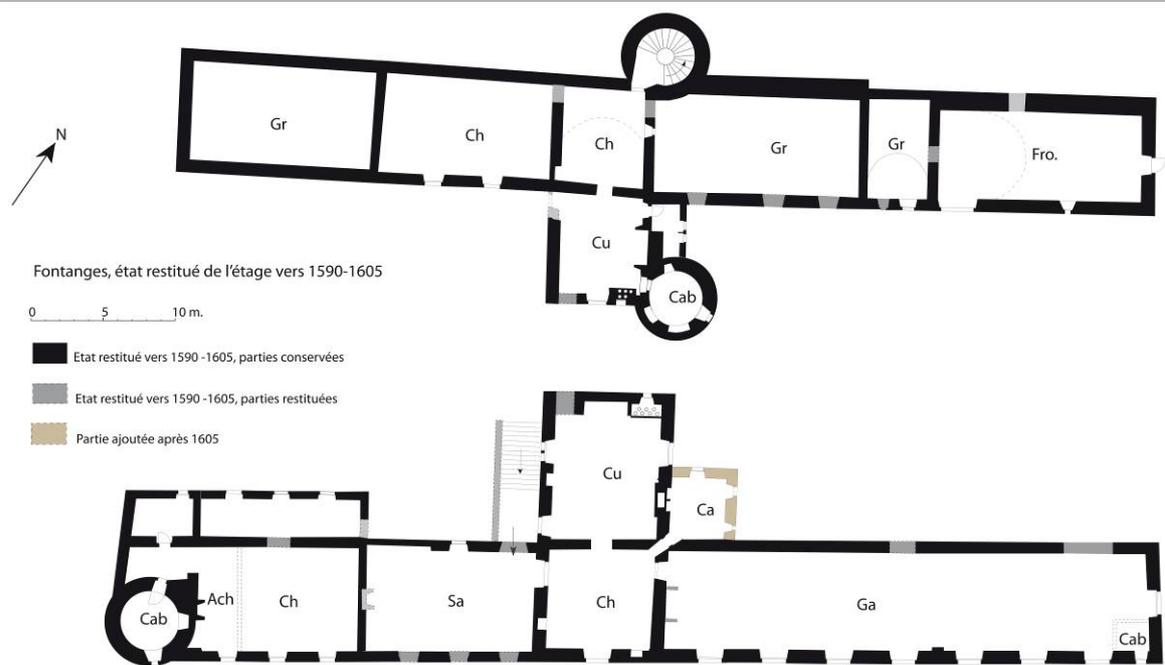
Plan restitué de l'étage vers 1590-1605.
